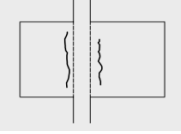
Descripción de fallas en construcciones de concreto reforzado
